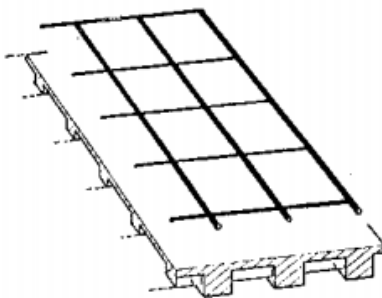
Malha de grelha para laje nervurada (Hambly, 1976)
